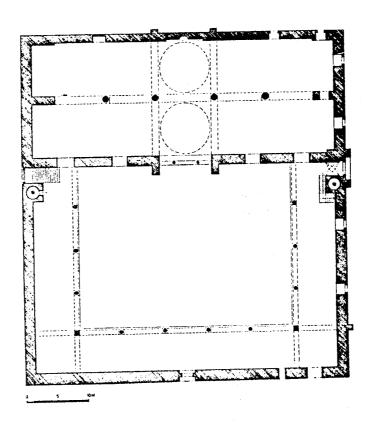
مسقط أفقي للجامع الكبير في دنيصر (قزيل تبه) (عن: آصلان آبا).
